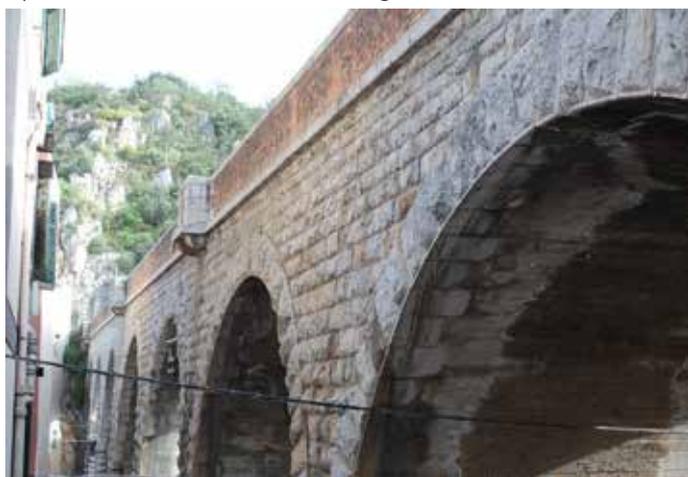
Vista d'insieme del Viadotto Boccadifalco dal basso
